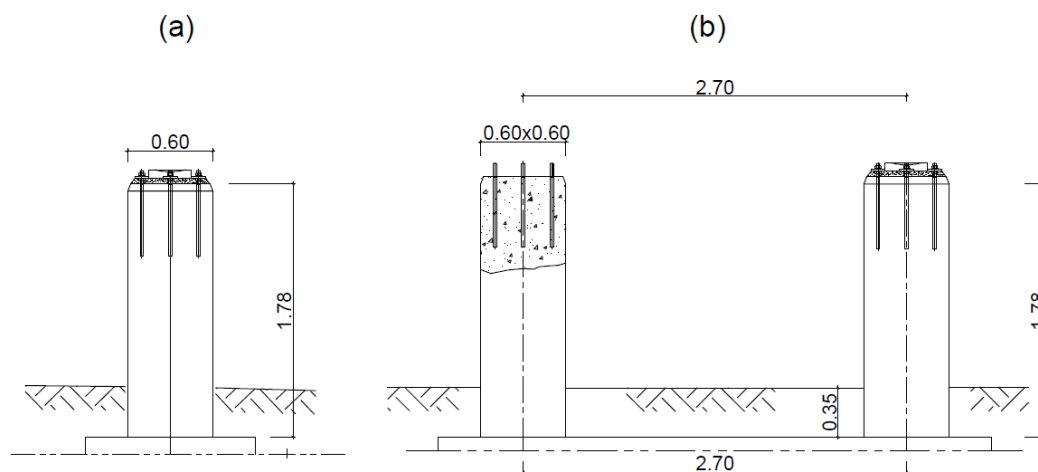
Geometria do pilar P1: (a) Alçado longitudinal; (b) Alçado transversal [2]
